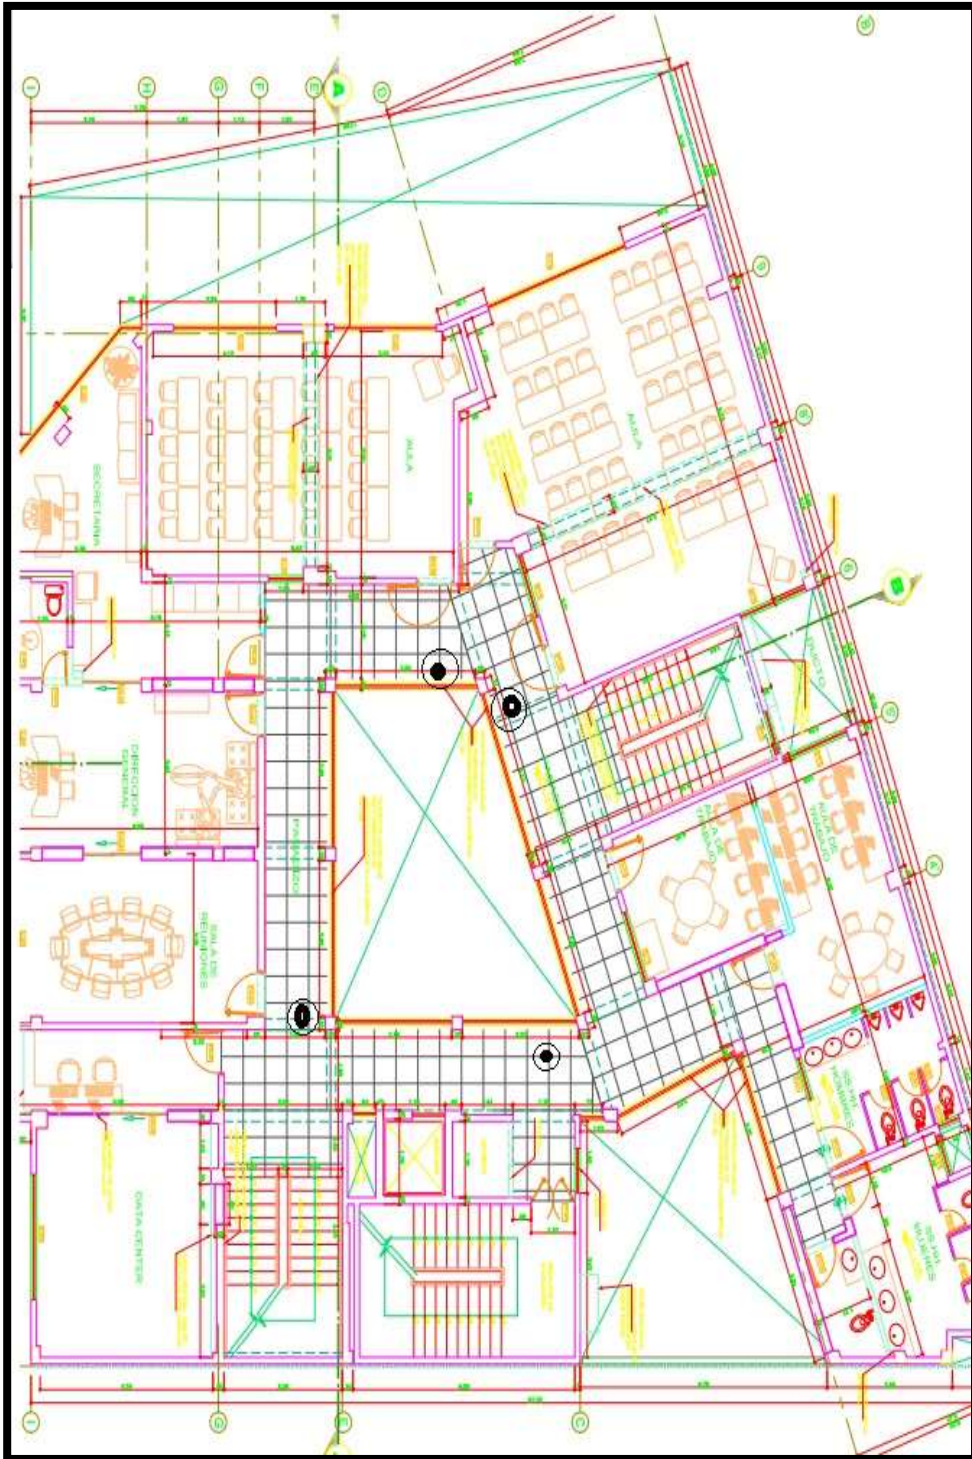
Plano de distribución de oficinas Piso 1 sede ENAP.
